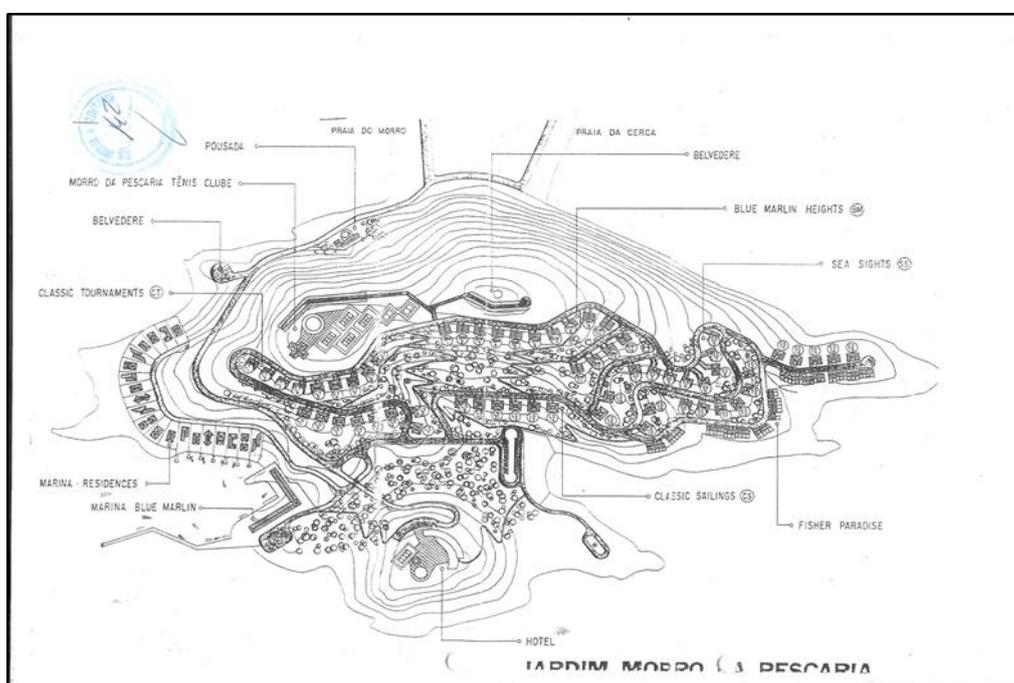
Planta do Loteamento Jardim Morro da Pescaria
